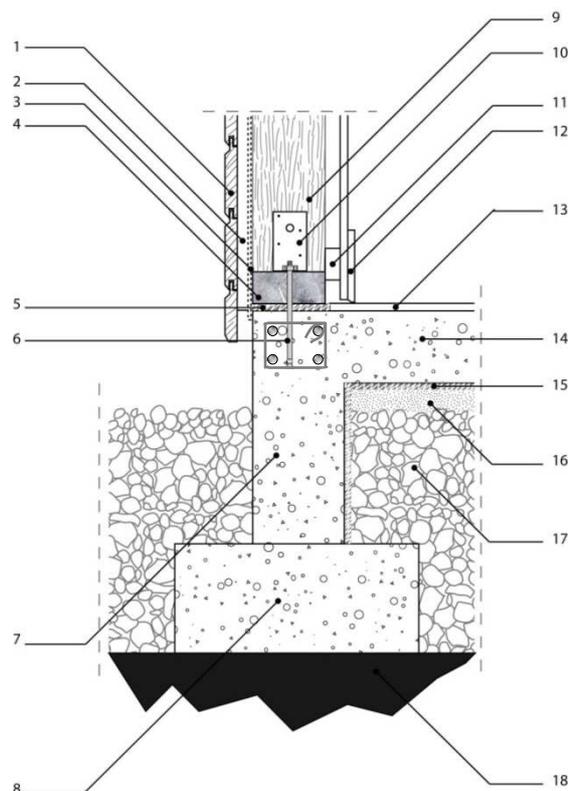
Coupe verticale de principe : Détail ancrage lisse basse murs extérieurs sur infrastructure béton armé - panneau courant secondaire de mur de façade
